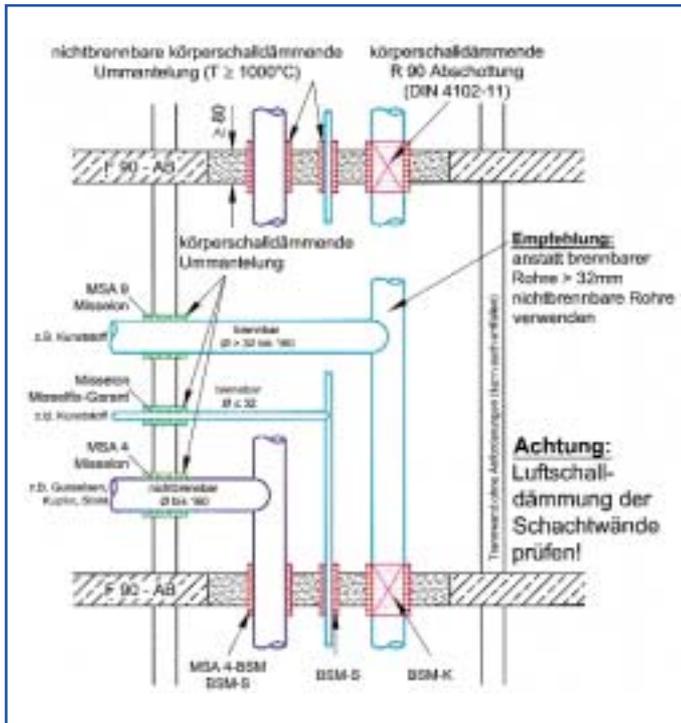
zeigt den F90-Installationsschacht nach DIN 4102 Teil 4 mit Sanitär- und Heizungsleitungen. Die Bilder 2 bis 4 unter-
